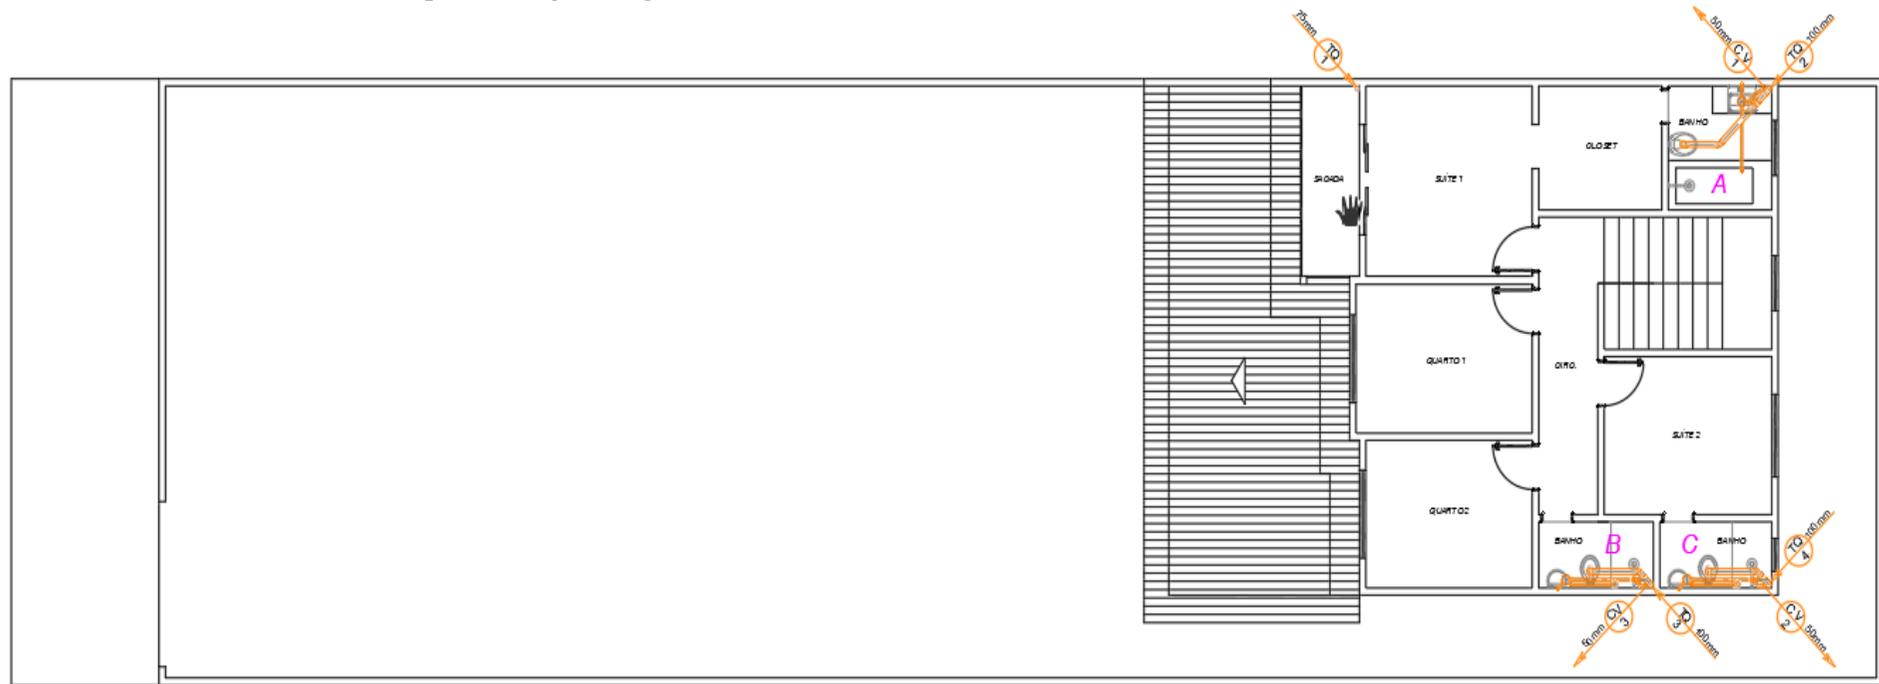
Planta Pavimento Térreo Projeto Esgoto
